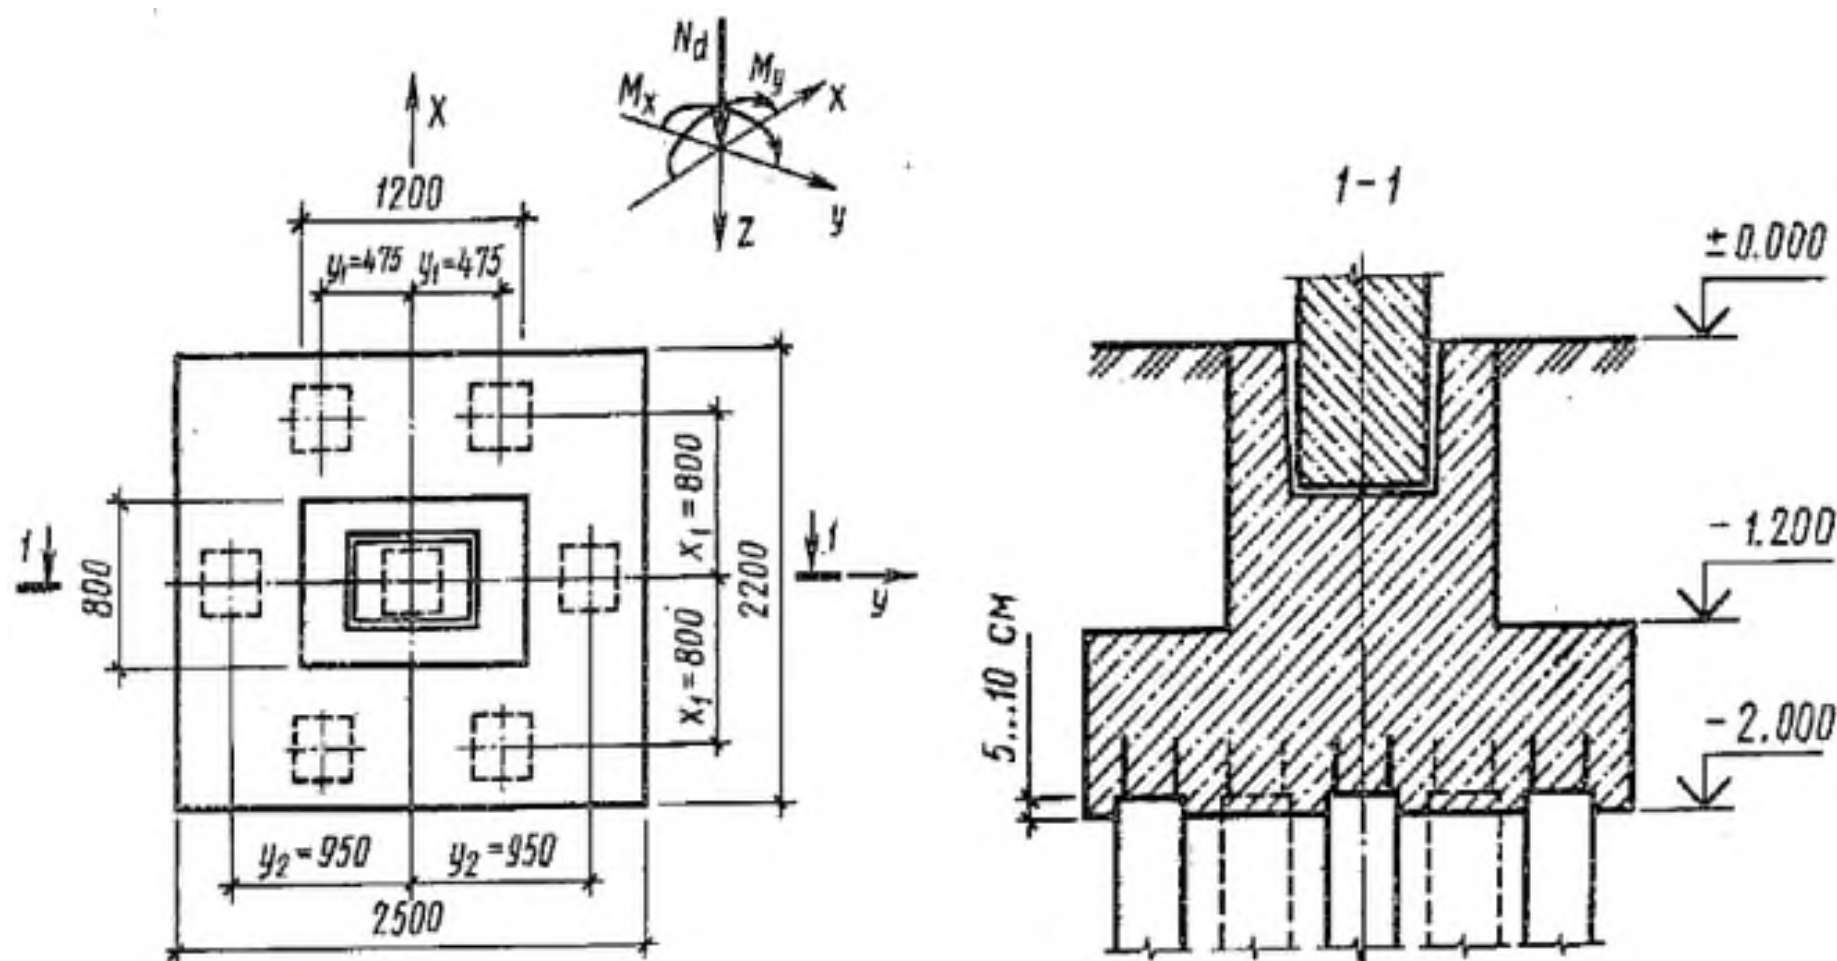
Внецентренно нагруженный свайный фундамент
